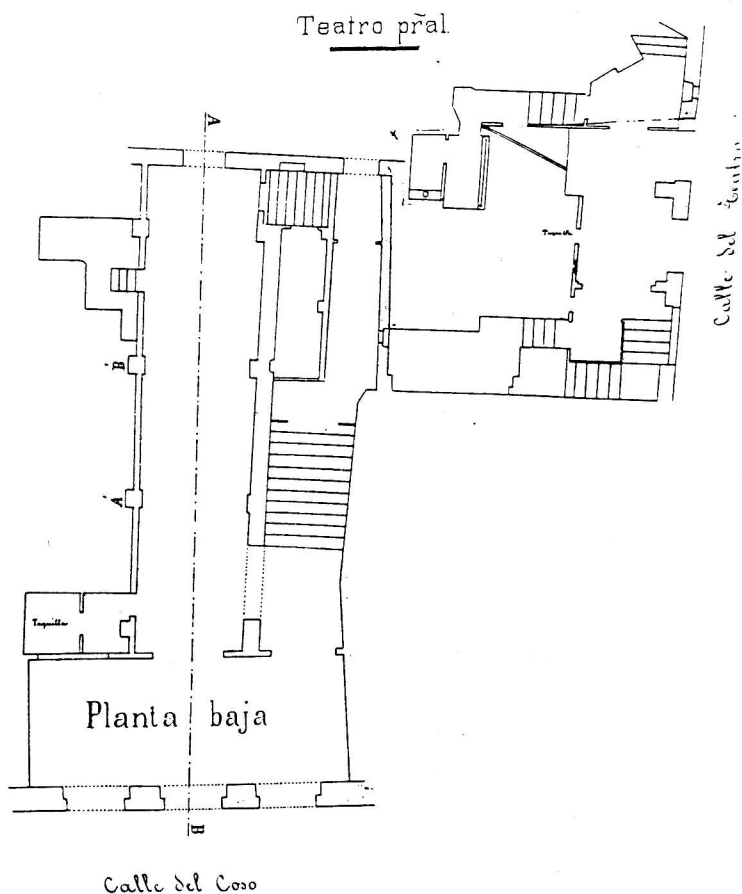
Planta baja de la entrada del Teatro Principal en 1875, según plano de Segundo Díaz (AMZ).
